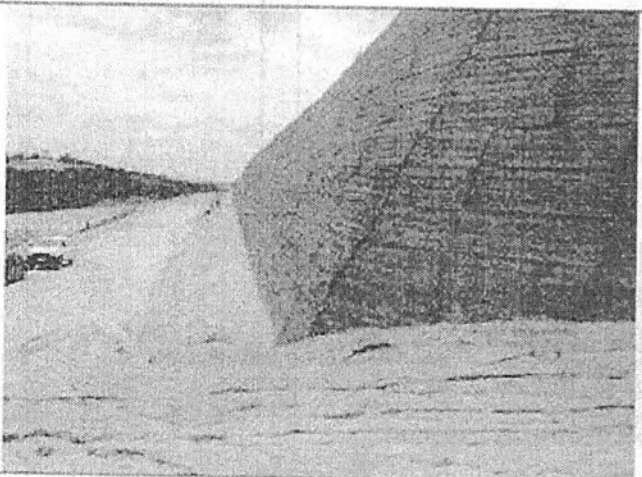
Vista da estrada de acesso à área do Aterro Classe I junto ao dique de contenção armado.
